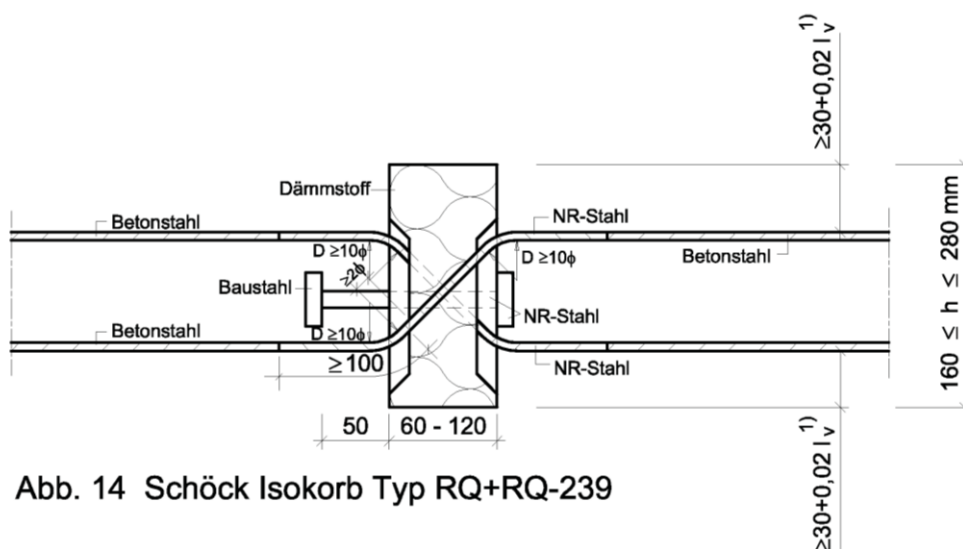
Schöck Isokorb Typ RQ+RQ-239
